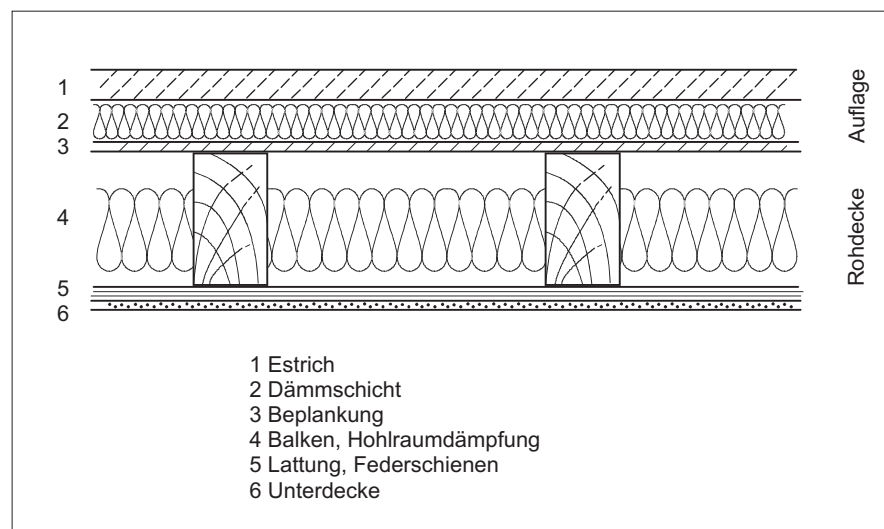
Konstruktion einer bauüblichen Holzdecke mit Estrichaufbau und Unterdecke
